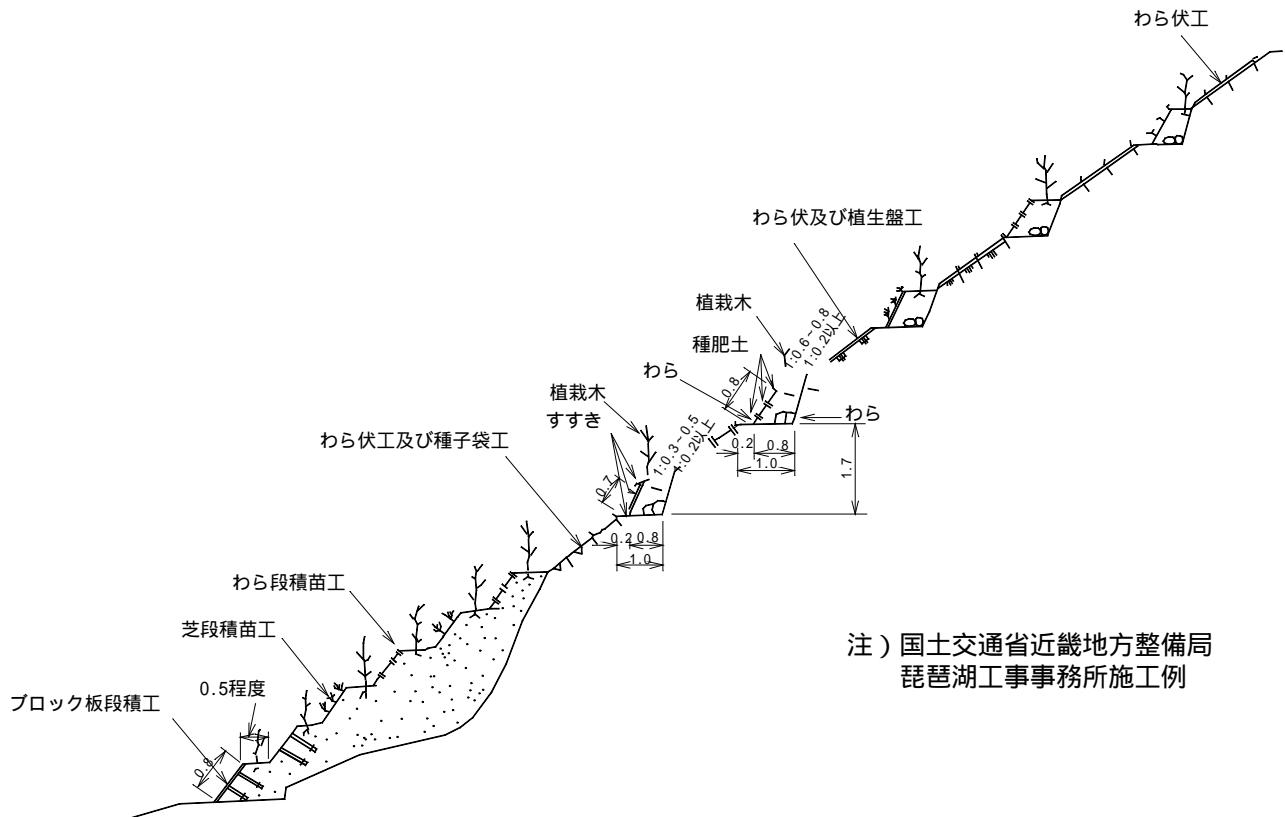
とくしゃ地(施工例)断面図 (単位:m)
